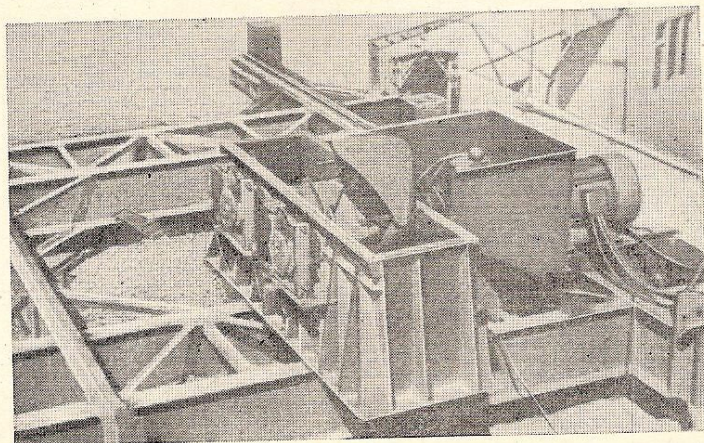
Вибромашина, установленная на уровне кровельной плиты 12-этажного здания
